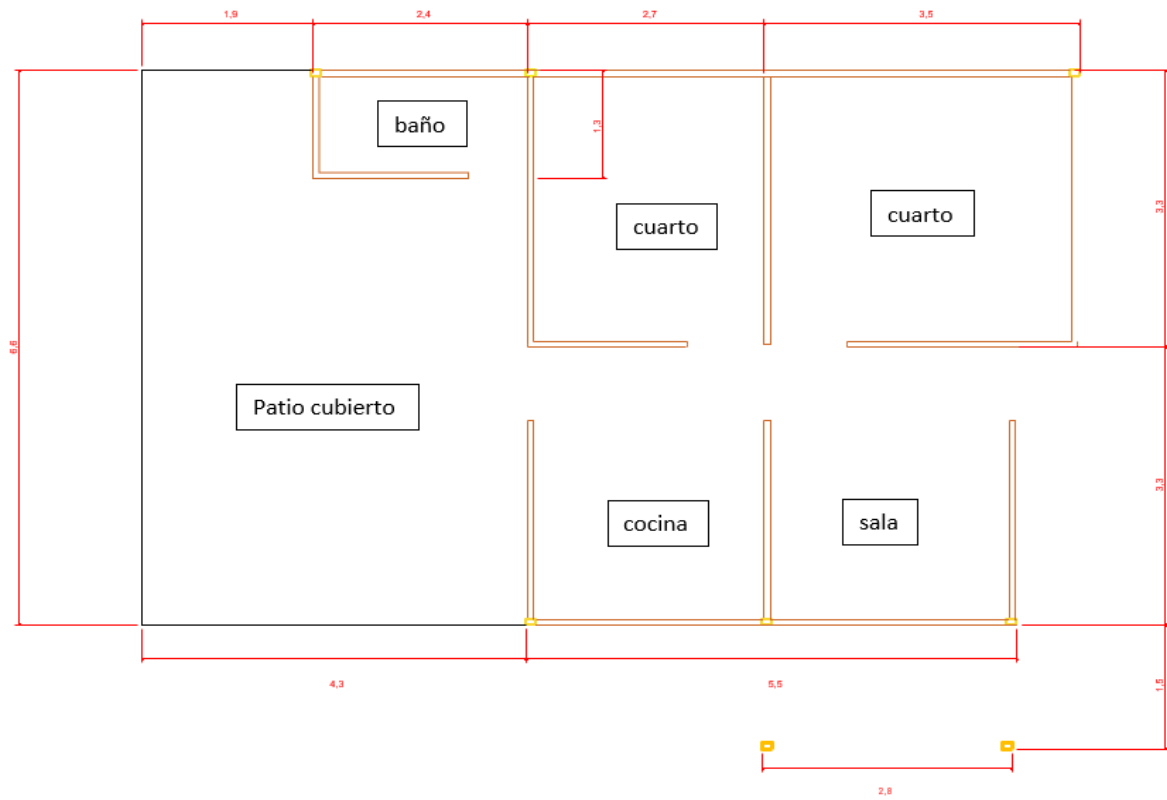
Distribución de muros de la vivienda en la primera planta
